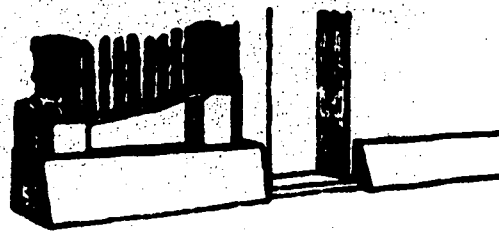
Detalles Constructivos de la vivienda Teotihuacana.
